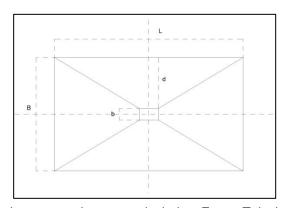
Dimensionamento de sapatas isoladas. Fonte: Teixeira; Godoy (1998)
